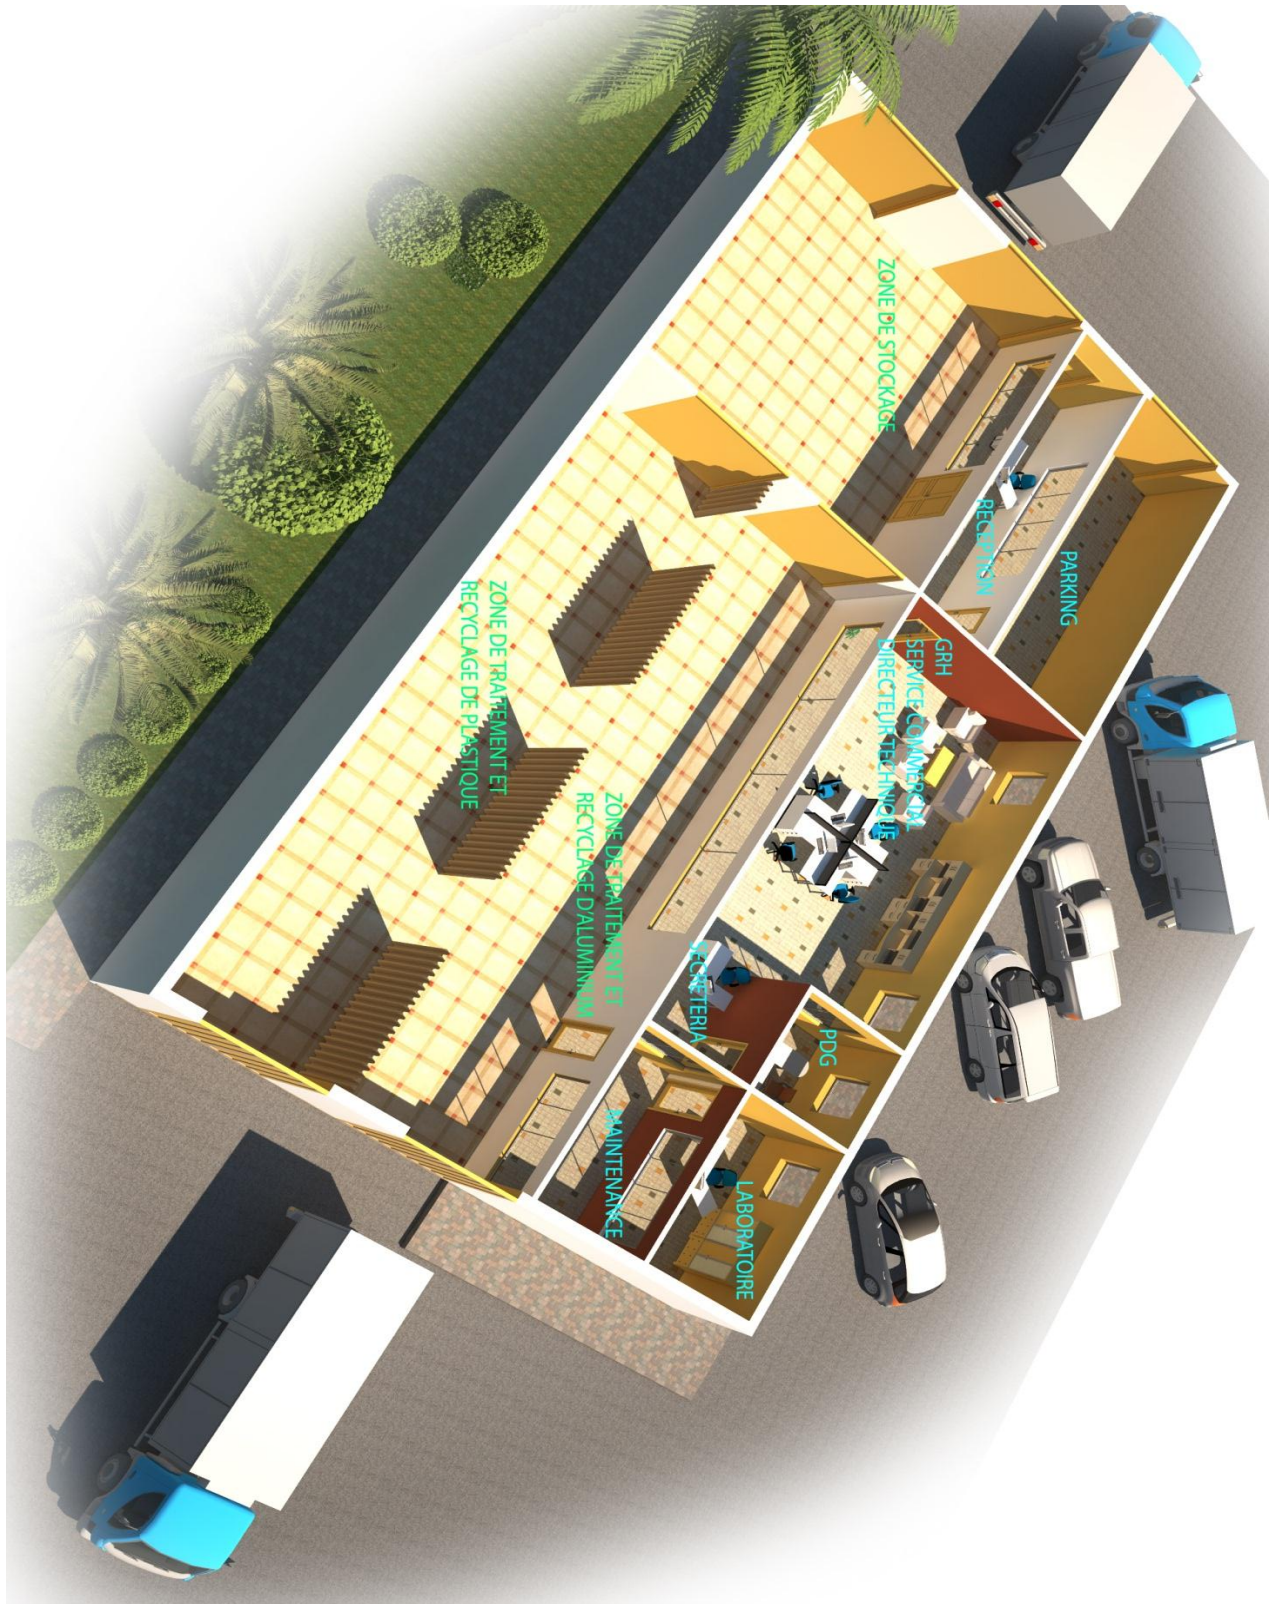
plan de notre usine de recyclage en 3 dimensions
